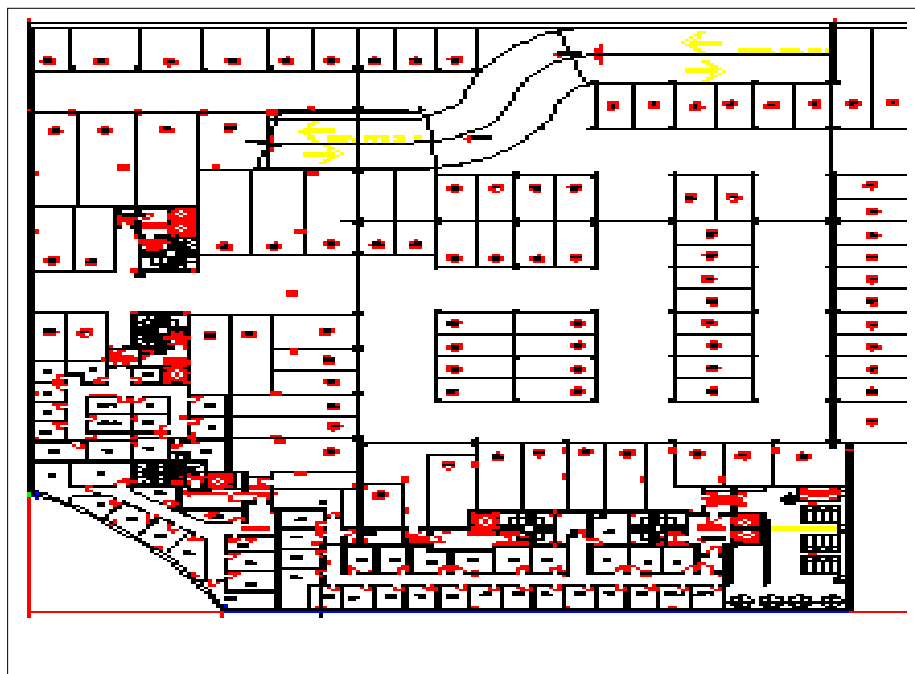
Vista en planta de la planta sótano 1. Fuente: Departamento de Ingeniería Térmica y de Fluidos, Universidad Carlos III de Madrid.
